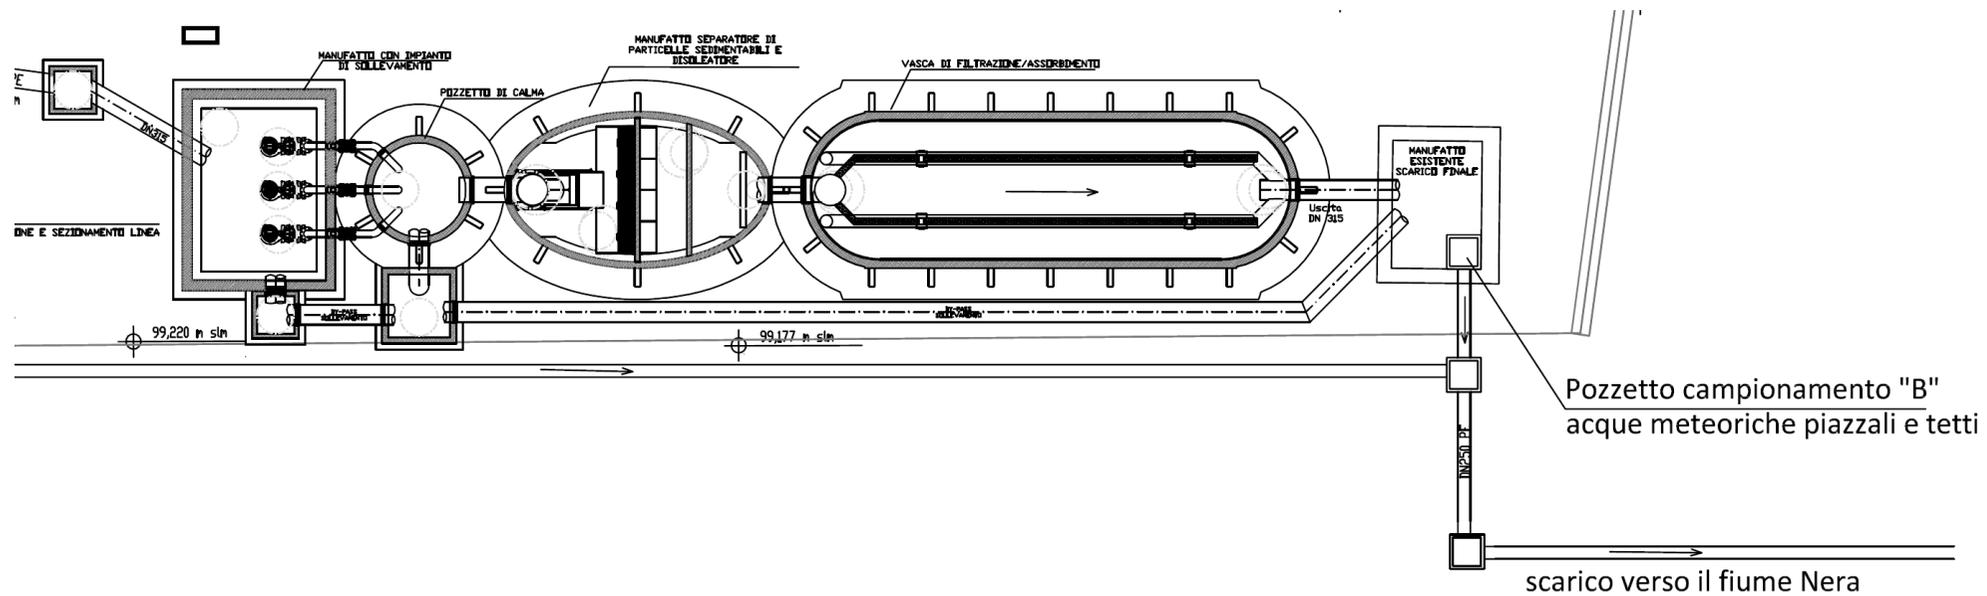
Pianta dell'impianto di trattamento delle acque meteoriche dei tetti e dei piazzali.
